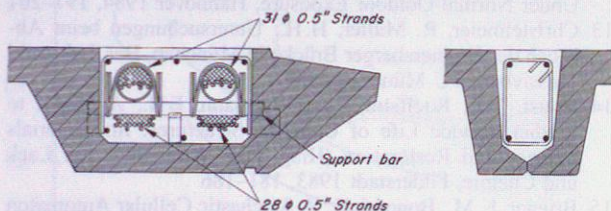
Details - Aussparung für Spannkabel und bewehrter Querträger. Details - recess for tension cable and reinforced crossbeam
